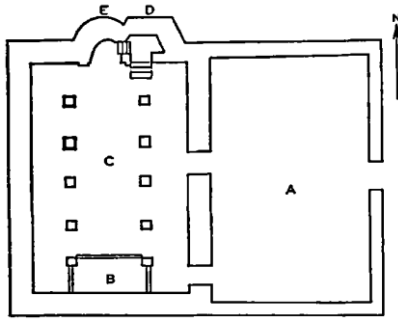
مسقط أفقي لمسجد كاولي الجامع المبكر/ تنزانيا
